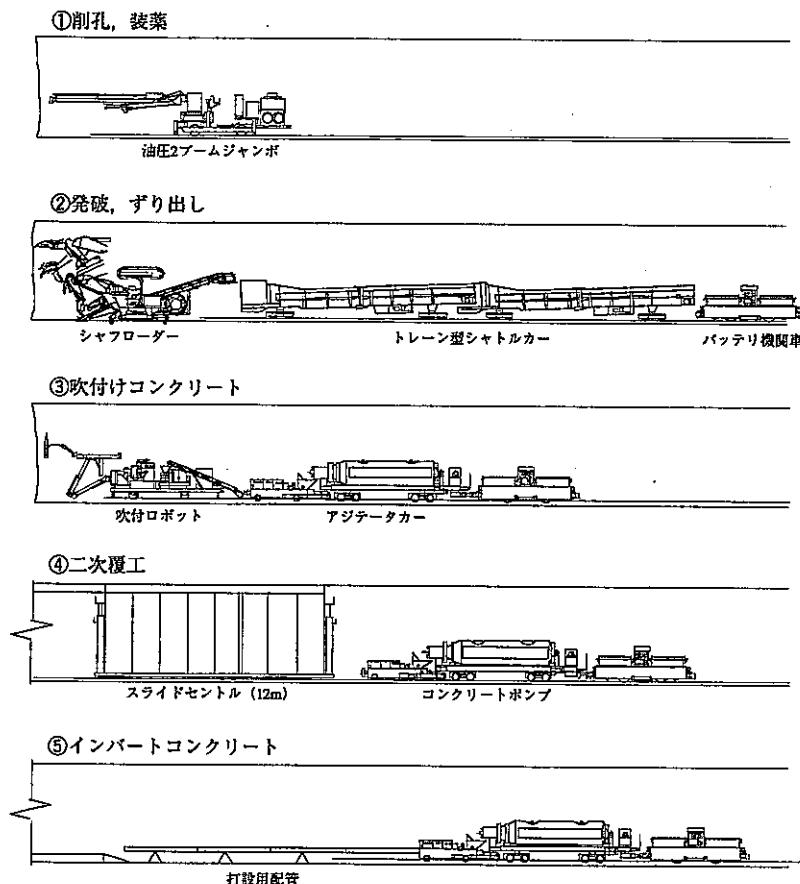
硬岩系岩盤における主要・連絡坑道の施工順序
